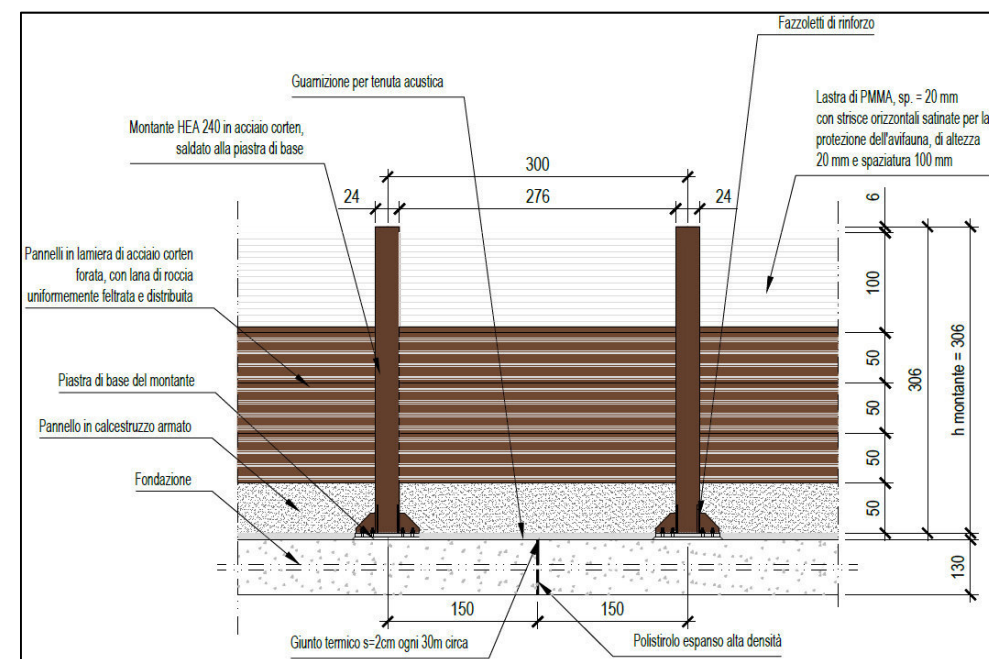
Prospetto delle barriere semitrasparenti da 3 metri
